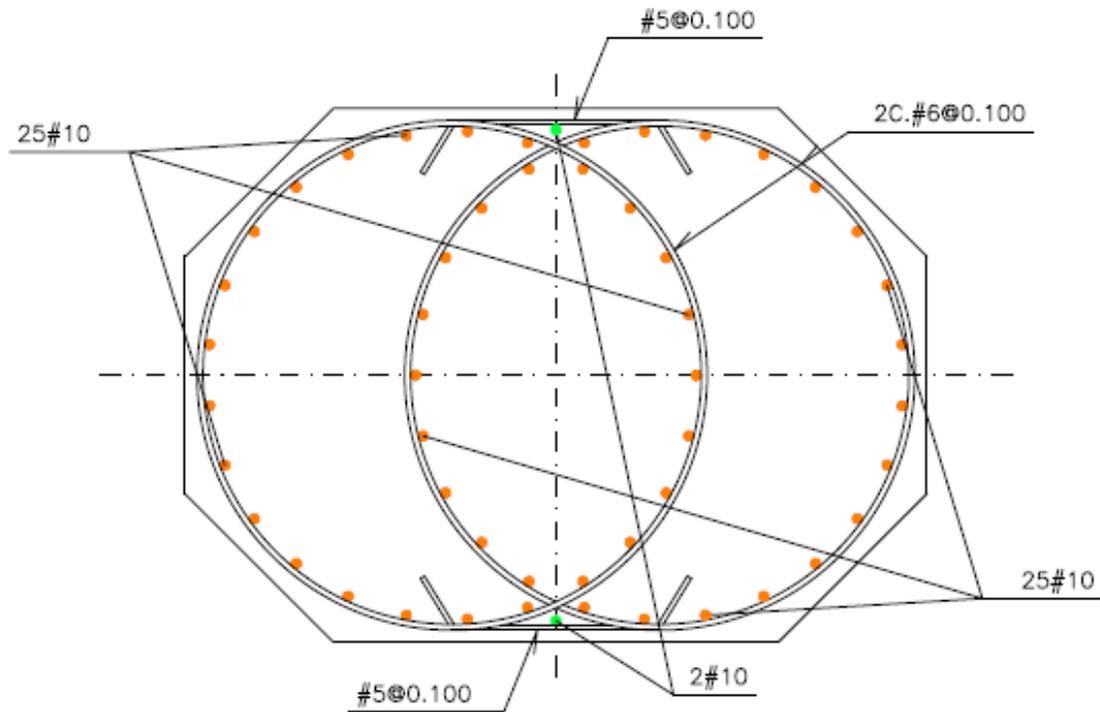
Sección de 2.50 m por 1.80 m para columnas
